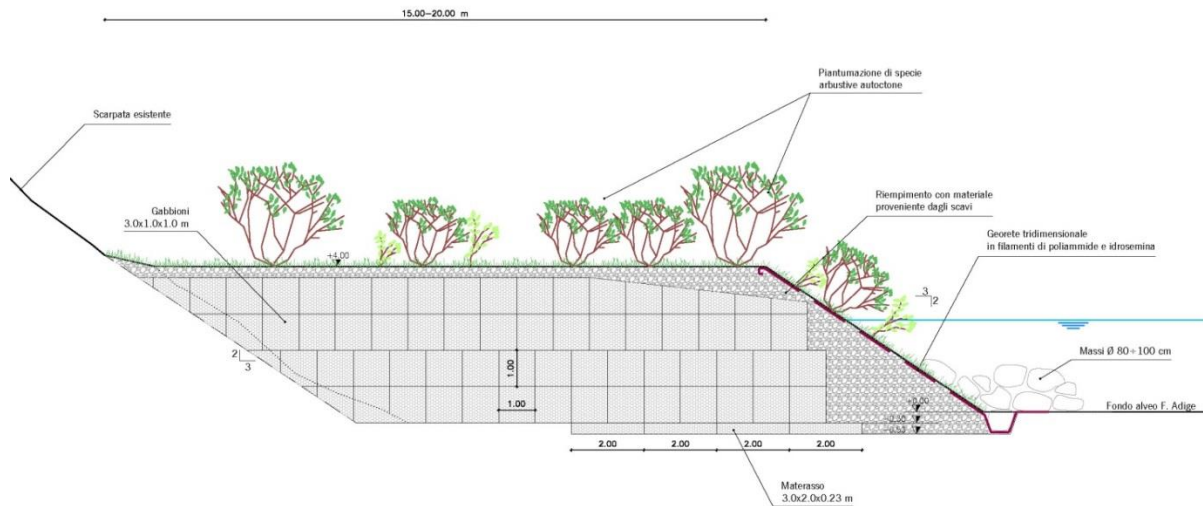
Pennello fluviale: sezione trasversale tipo.
